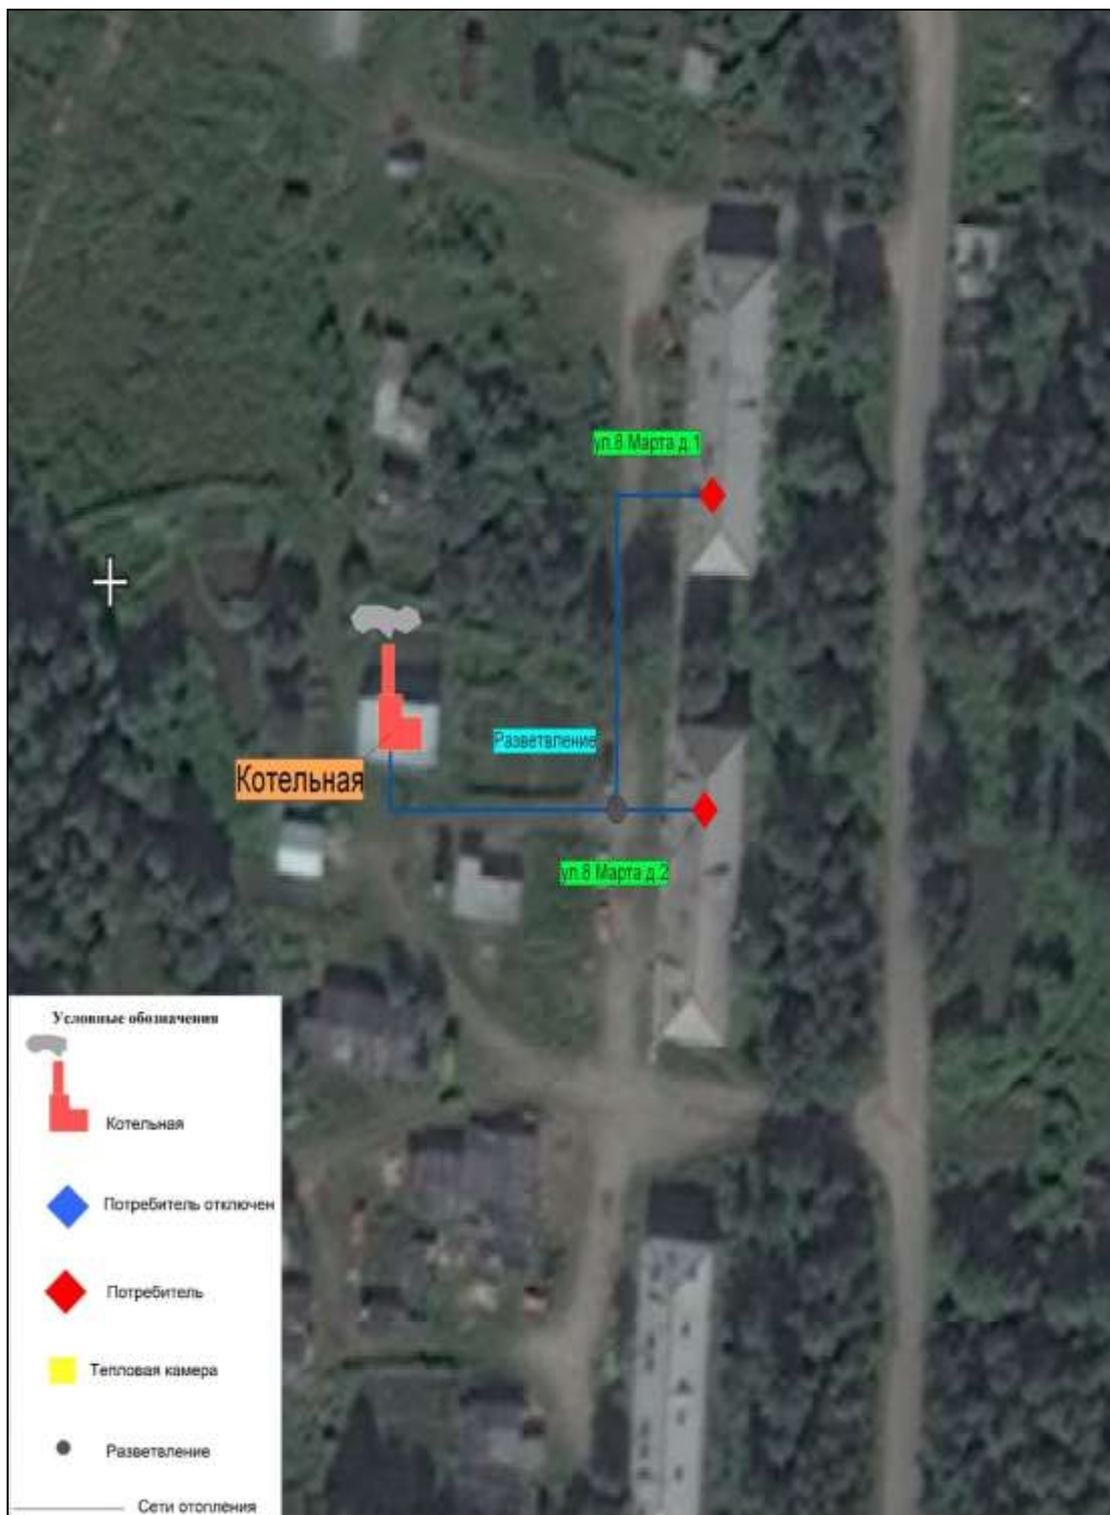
Схема тепловых сетей от котельной №2
